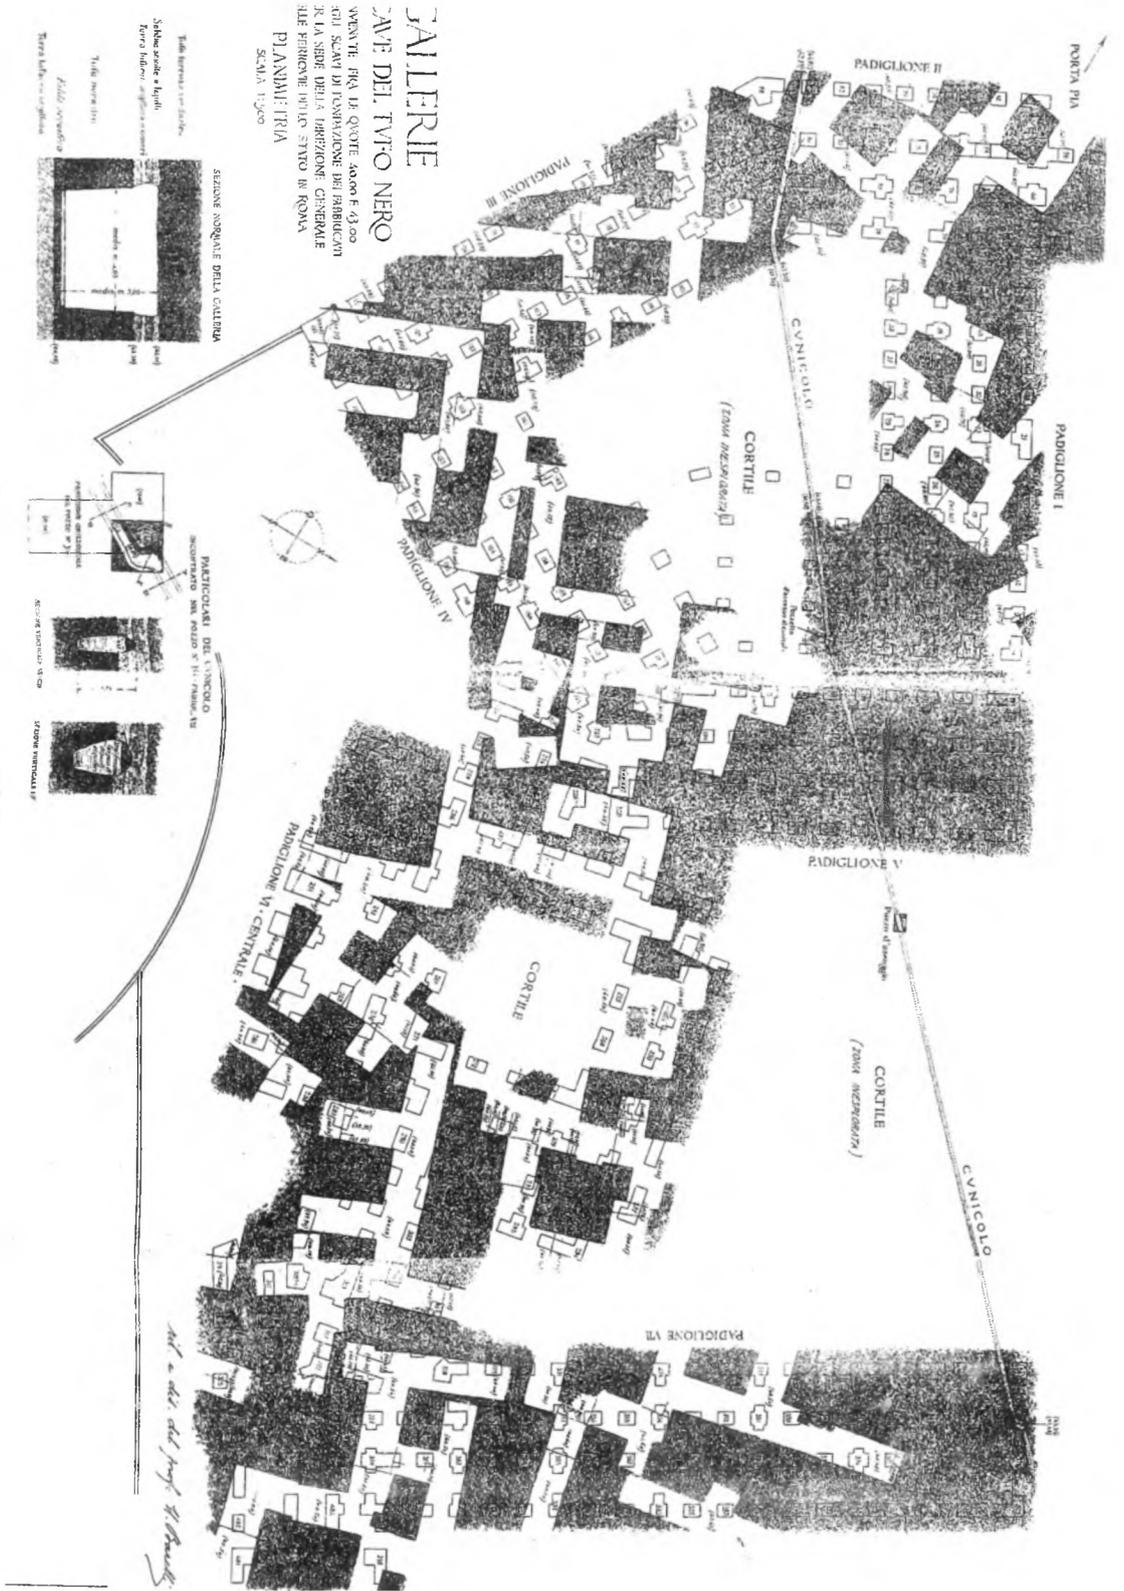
Roma, cava di Villa Patrizi, pianta generale e sezione delle gallerie (da LANCIANI 1918, ridotto).
